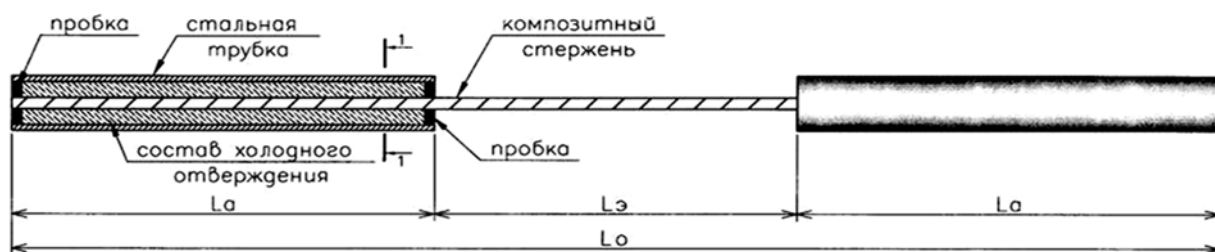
Типовое анкерное устройство для физико-механических испытаний НКА
